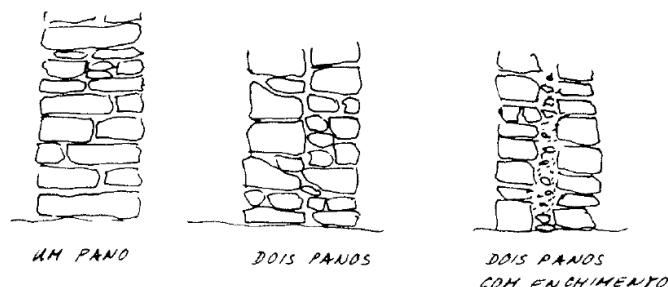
Esquemas construtivos de paredes de alvenaria simples ou de dois panos (Mascarenhas, 2003).
